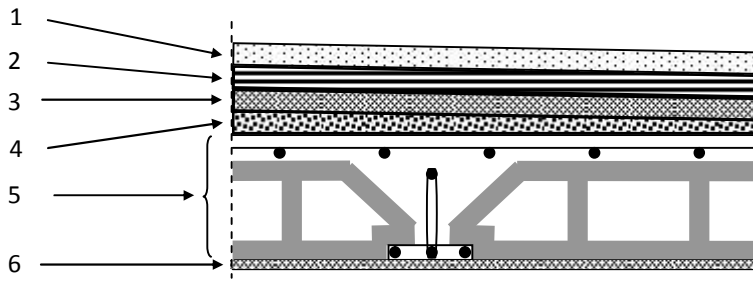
Coupe verticale dans le plancher terrasse inaccessible.
